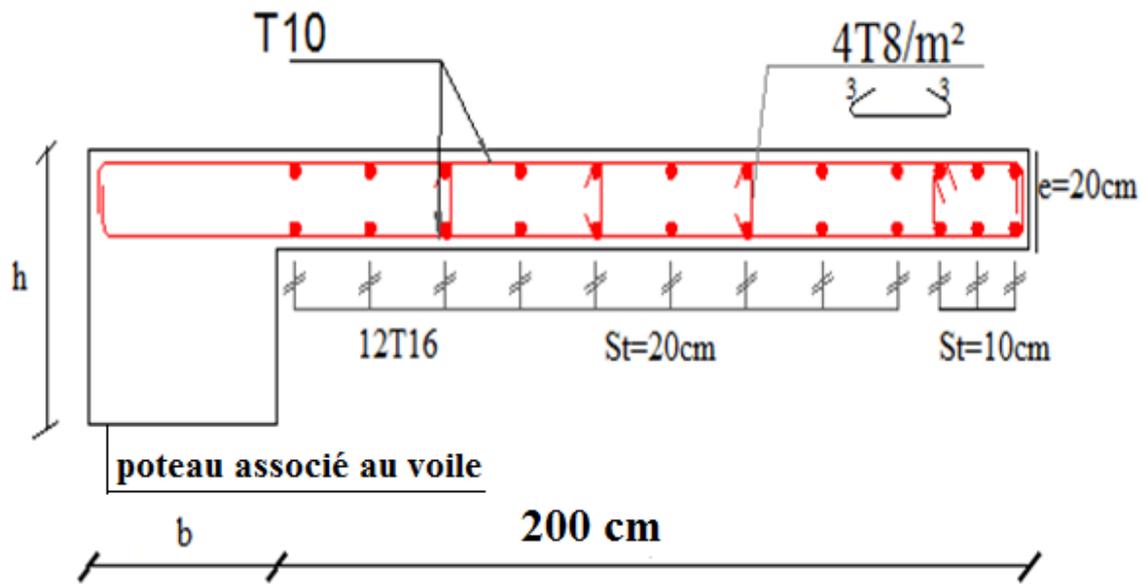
Schéma de ferrailage du voile Vy1 au niveau des entre-sol
